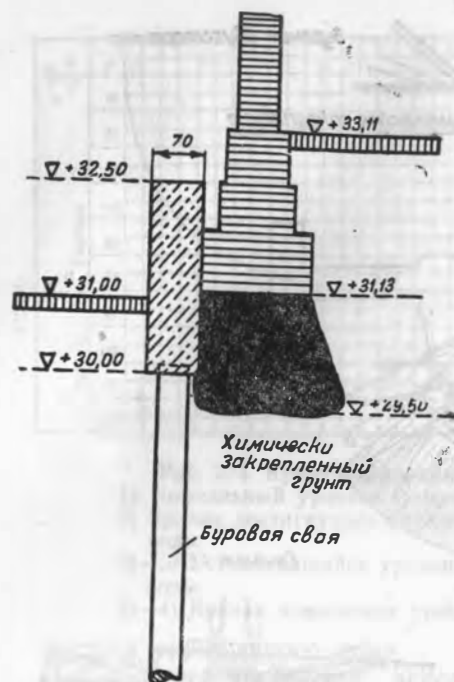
Подводка фундамента дома методом химического укрепления грунта.
